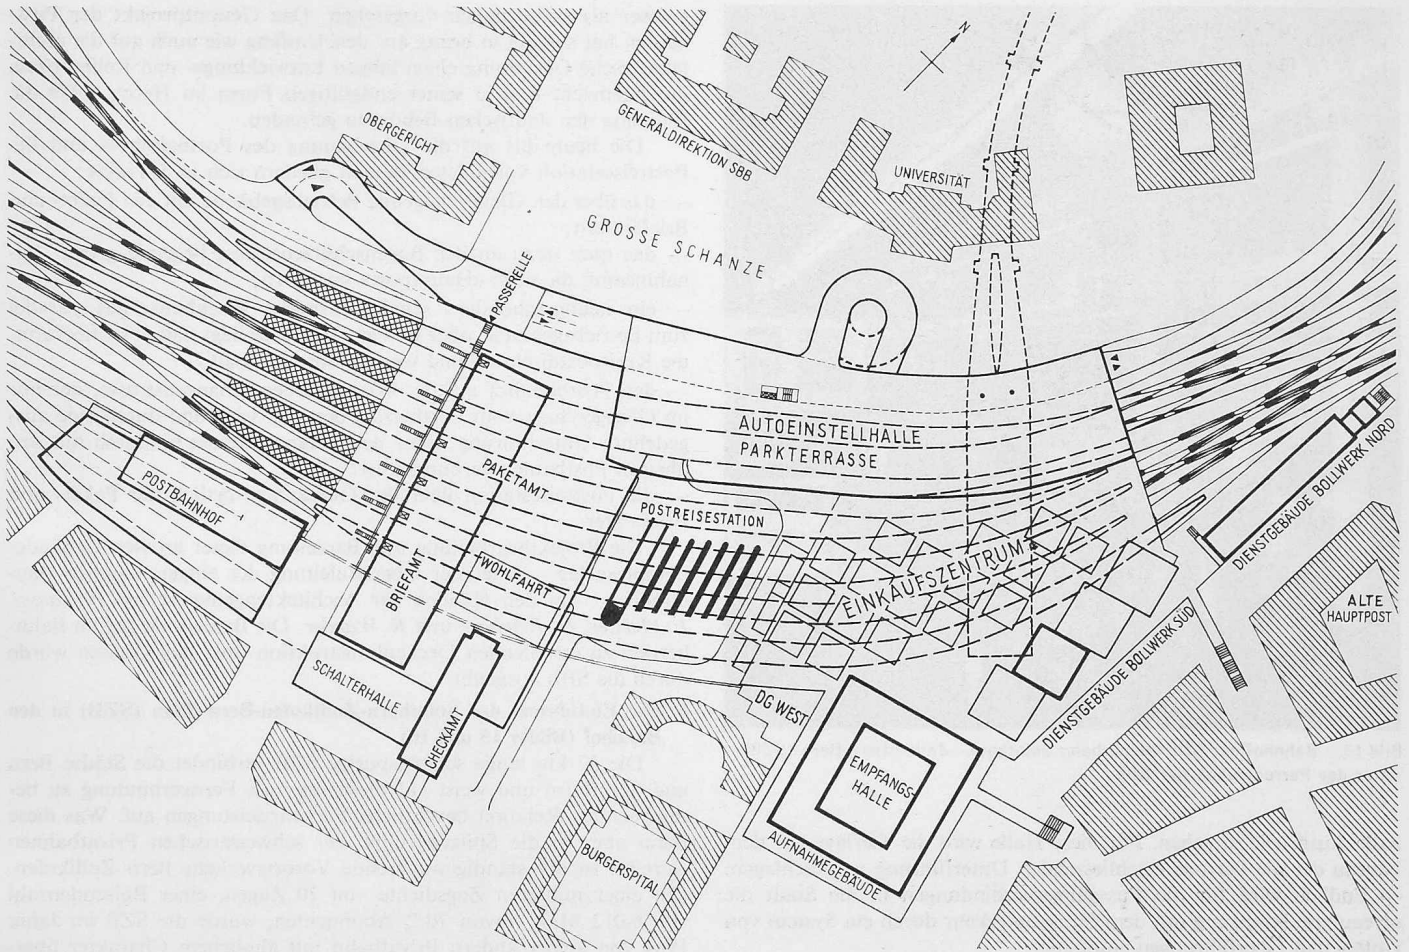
Bahnhof Bern, Hochbauten, Lageplan 1:3000
